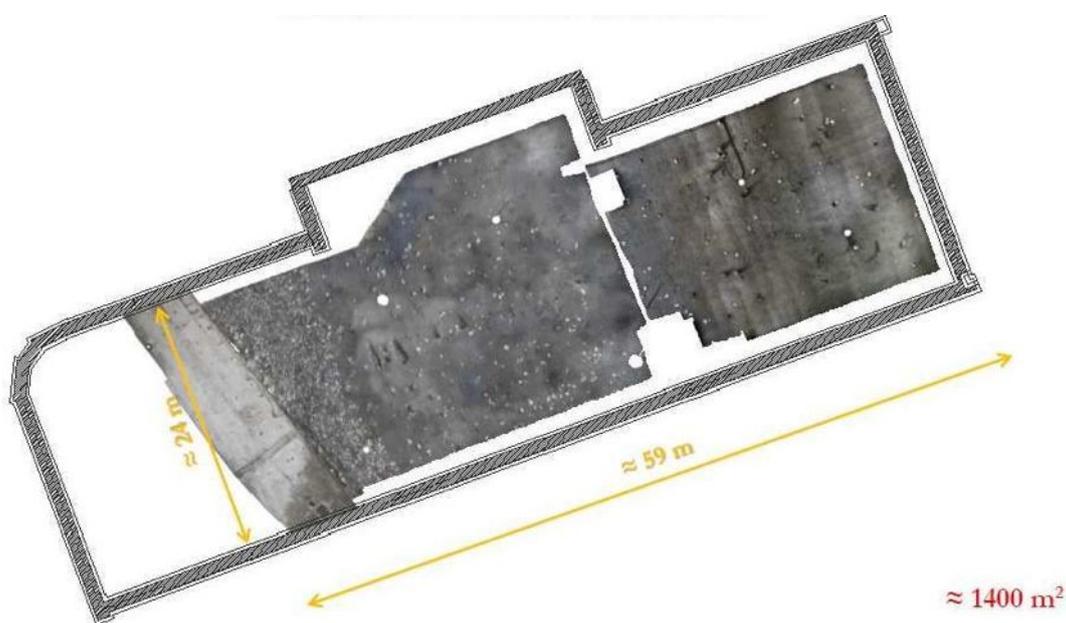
Ortofoto con estensione dell'area dei fondali, Laboratorio He.Su.Tech.
